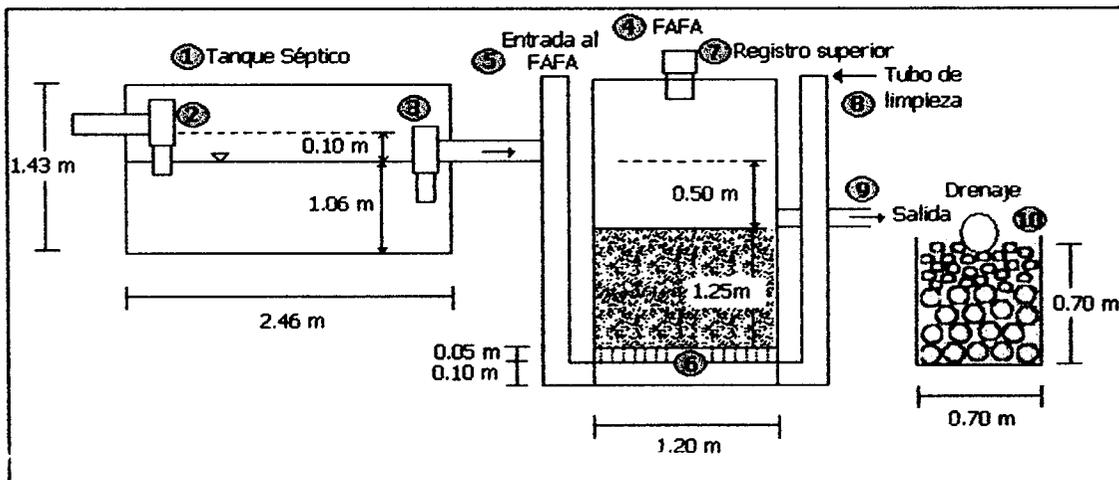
Esquema transversal del sistema: Tanque - FAFA - drenaje
